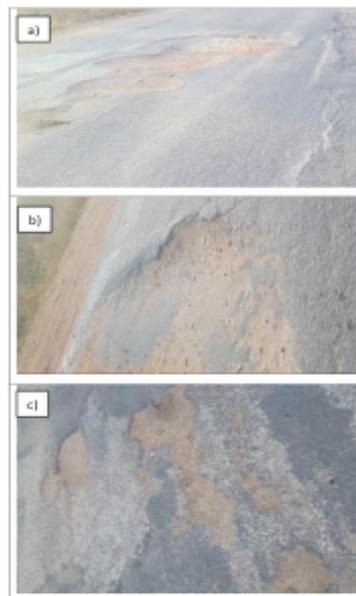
a) e b) panelas presentes no pavimento do trecho A, c) panelas presentes no pavimento do trecho C.
